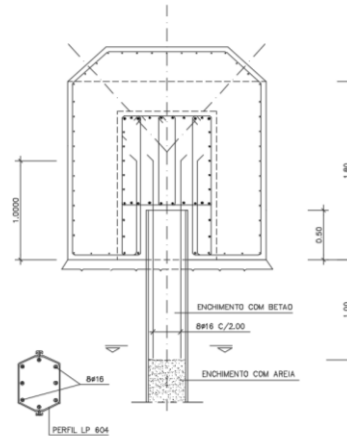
Dique e maciço de fundação do passadiço (fonte: Imoconsult / WW)
